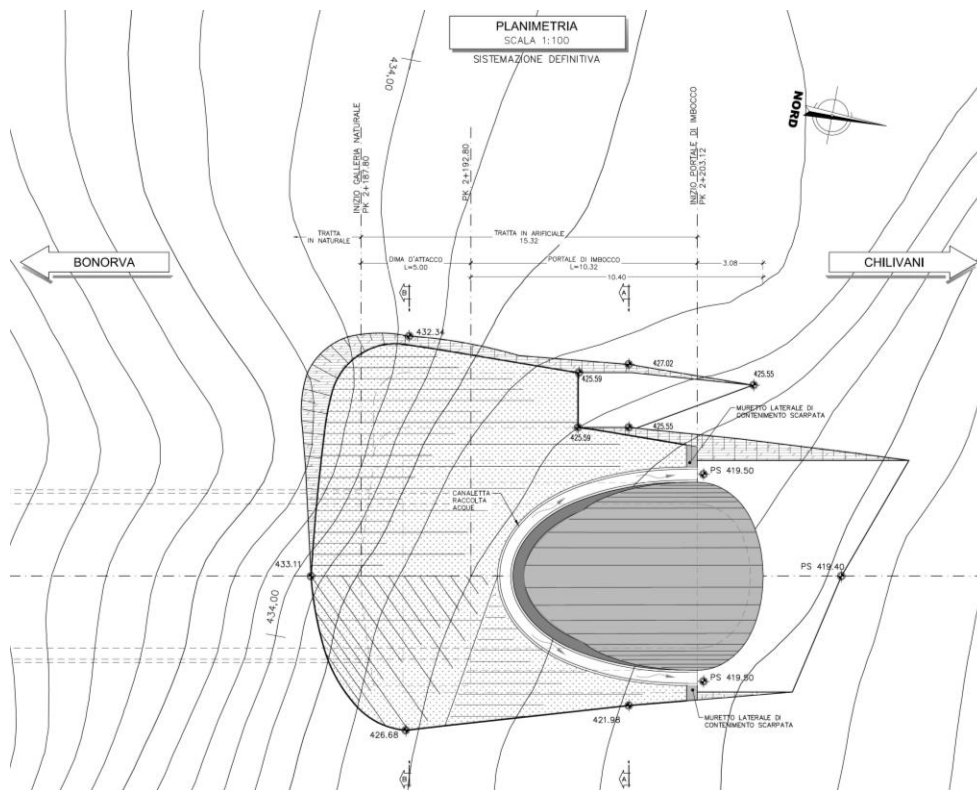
Galleria Monte Martis – Imbocco lato Chilivani – Planimetria in fase definitiva
